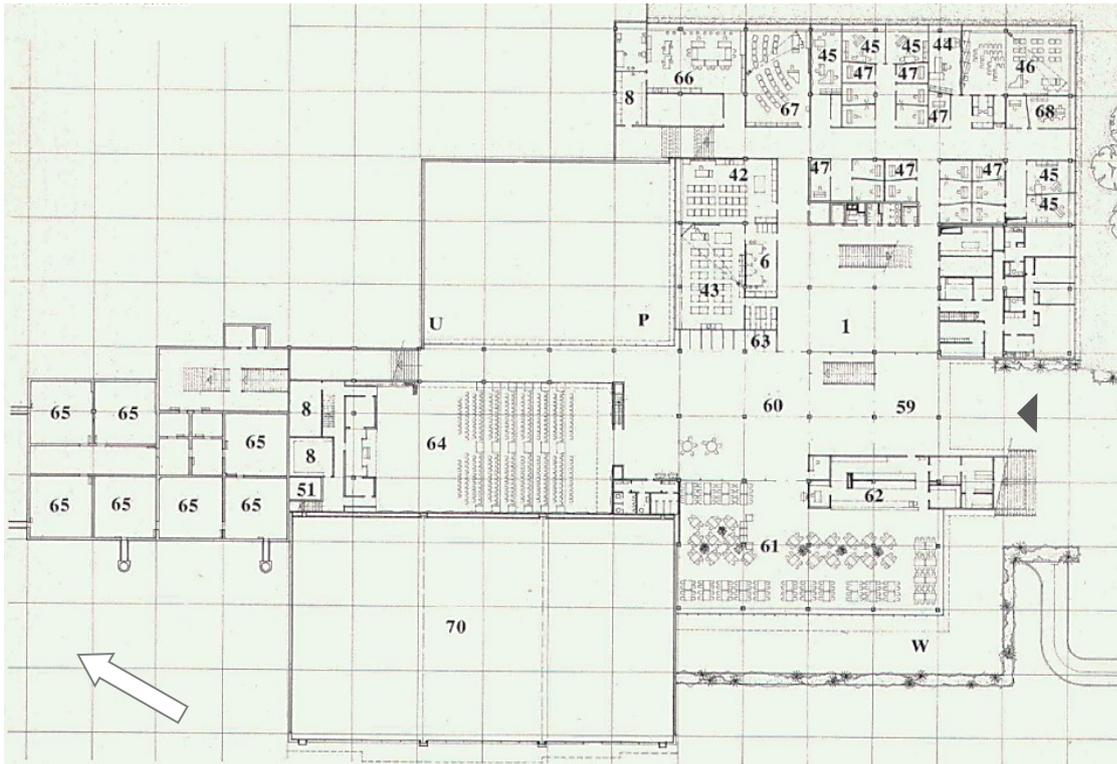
Grundriss Niveau 2 mit dem Haupteingang, (Werk, Heft 7/8, 1976, S. 500)
